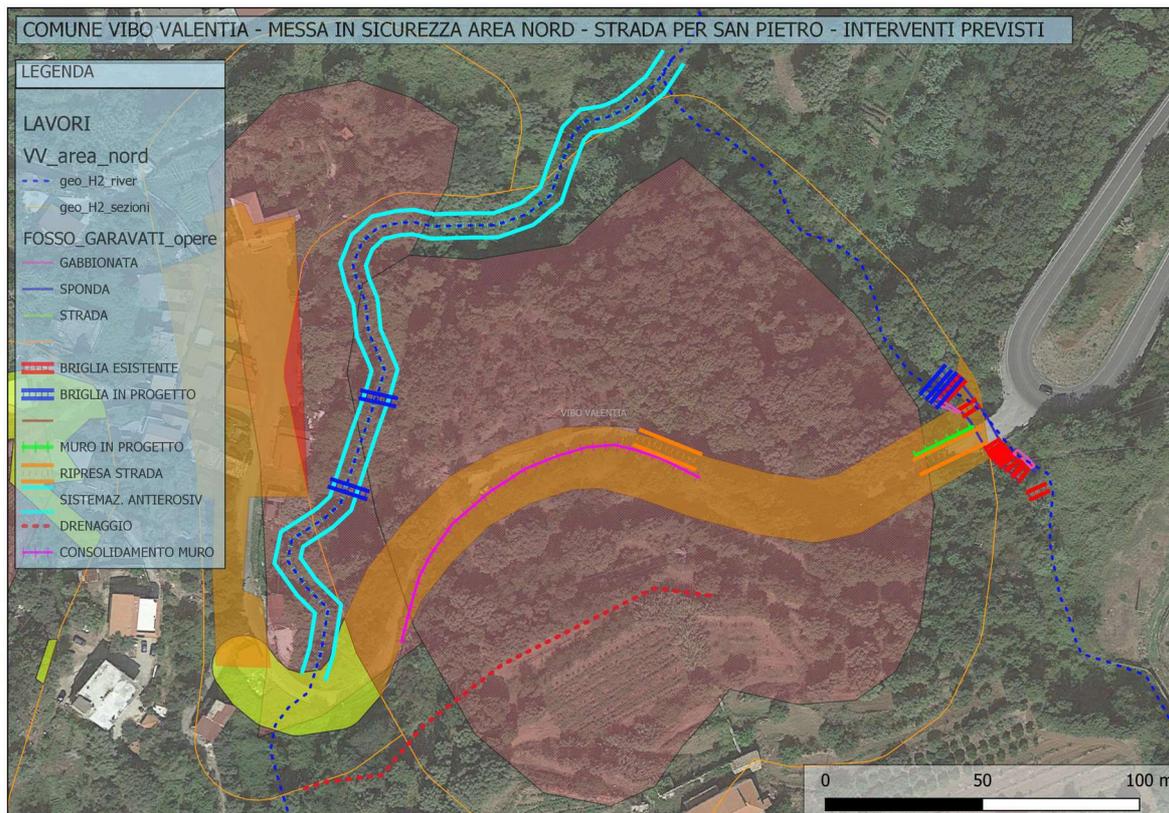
Planimetria generale interventi previsti sovrapposti alle aree in frana – base ortofoto
